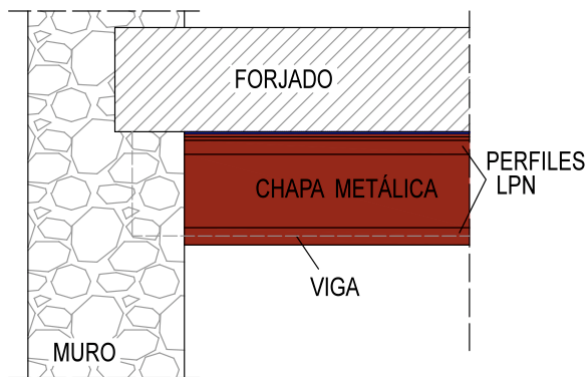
Refuerzo de viga mediante chapas metálicas y perfiles LPN. Fuente propia.
